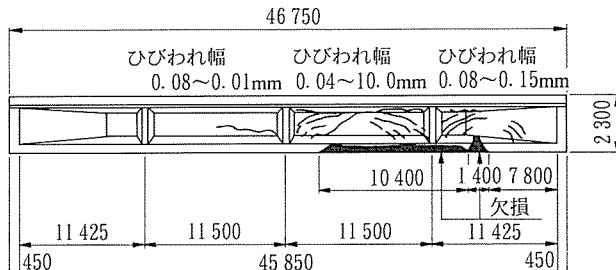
P 102～P 103 径間 耳桁 (G 1) 損傷状況
